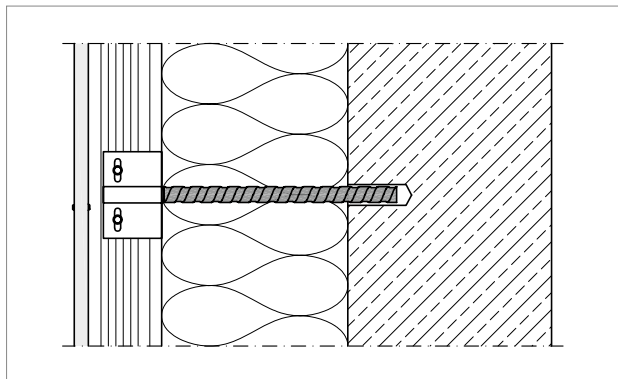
Schöck Isolink® Typ F: Verankerung im Beton
